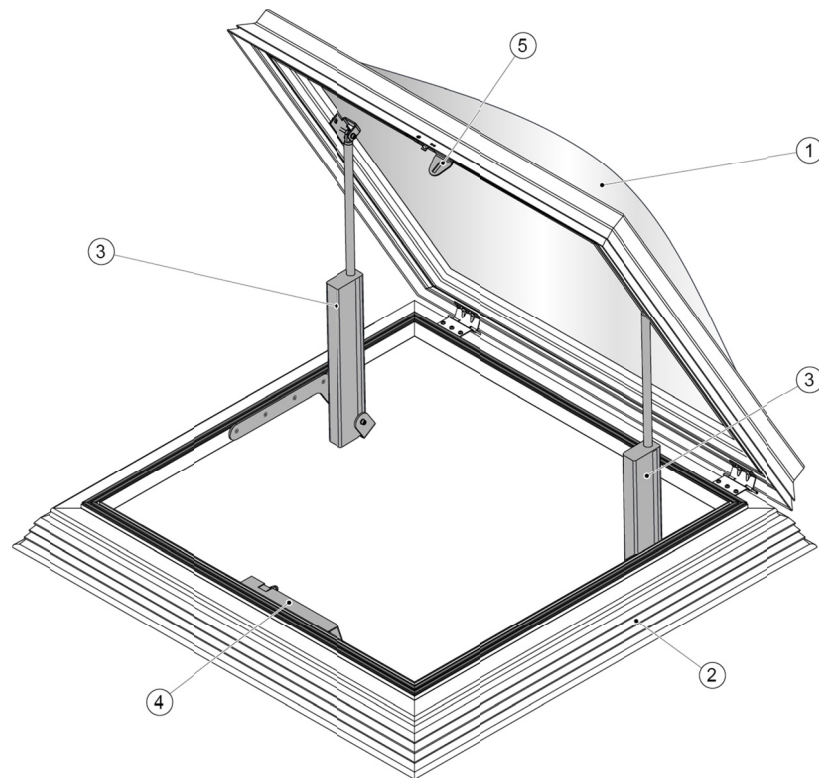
Produktbeschreibung Dachausstieg mit Motoröffner
